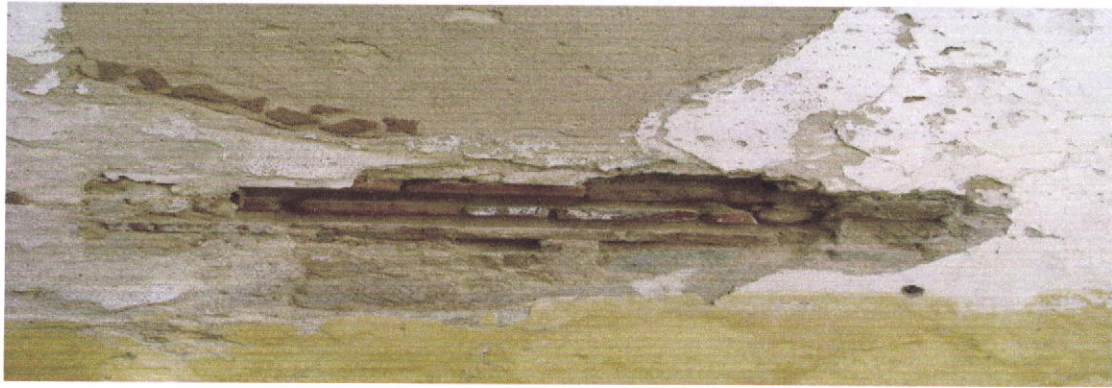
Tijolo burro utilizado na construção das paredes. Rua dos Açougues. (foto do autor)
